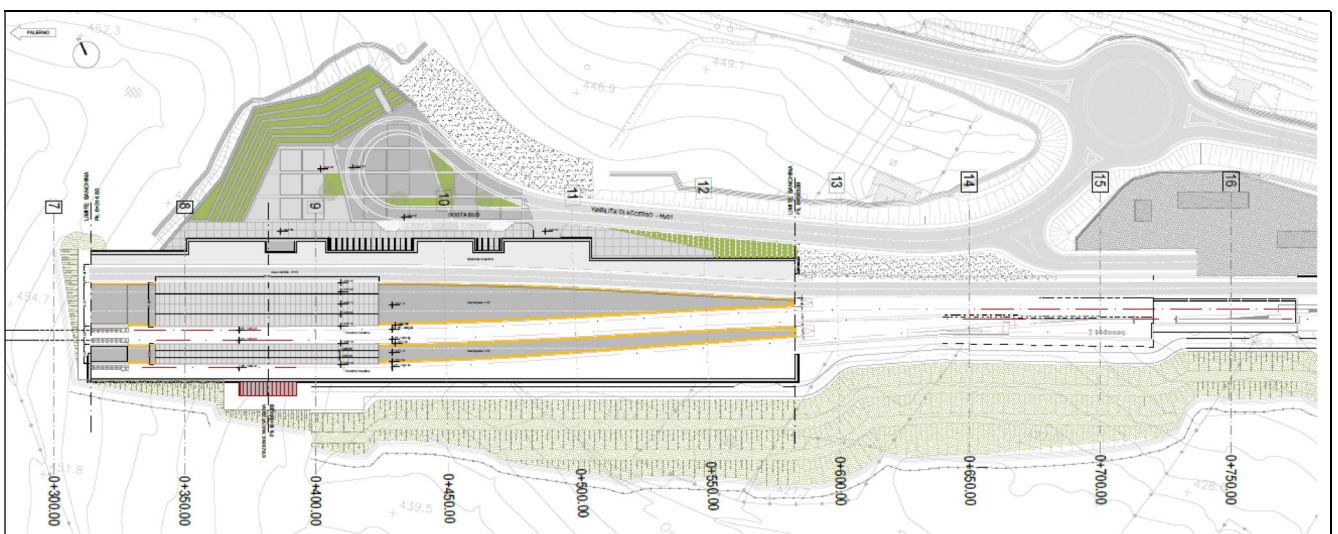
Stazione di Nuova Enna: Stralcio planimetrico
